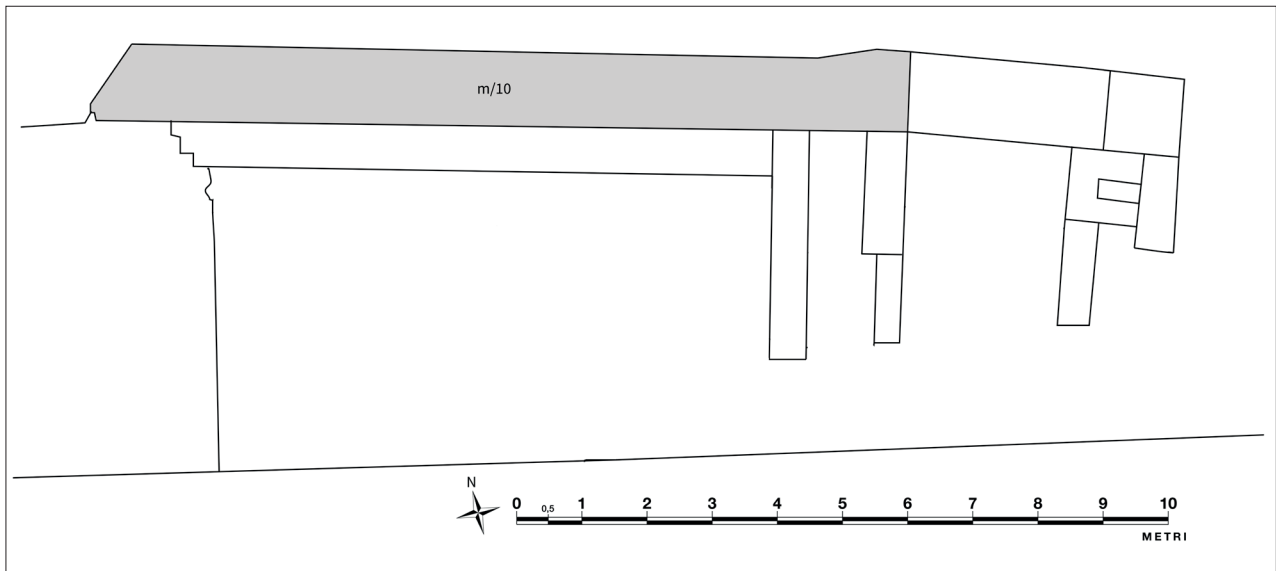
Pianta schematica delle strutture attribuite alla Fase costruttiva 1 dell'edificio
